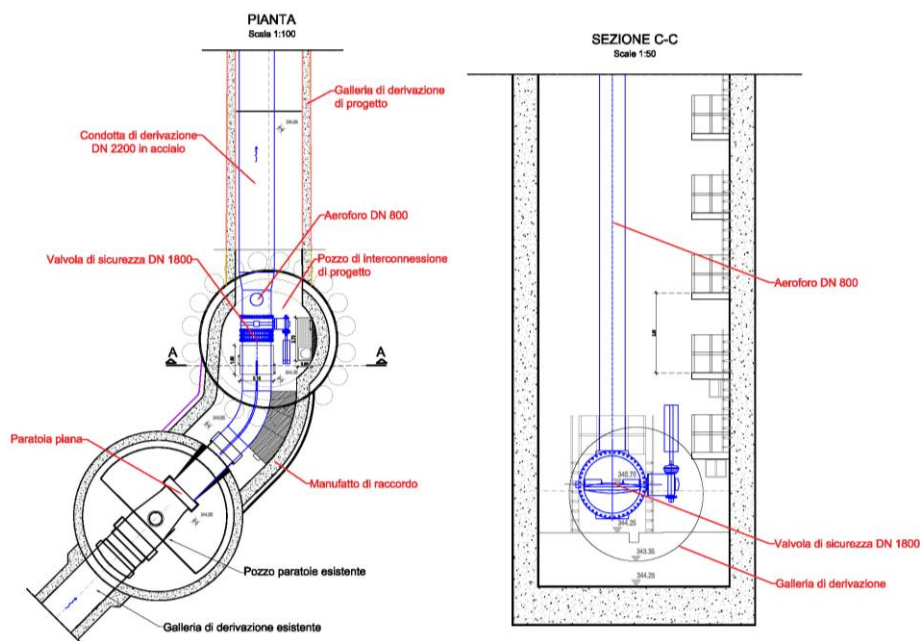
Manufatto di interconnessione, pianta e sezione
